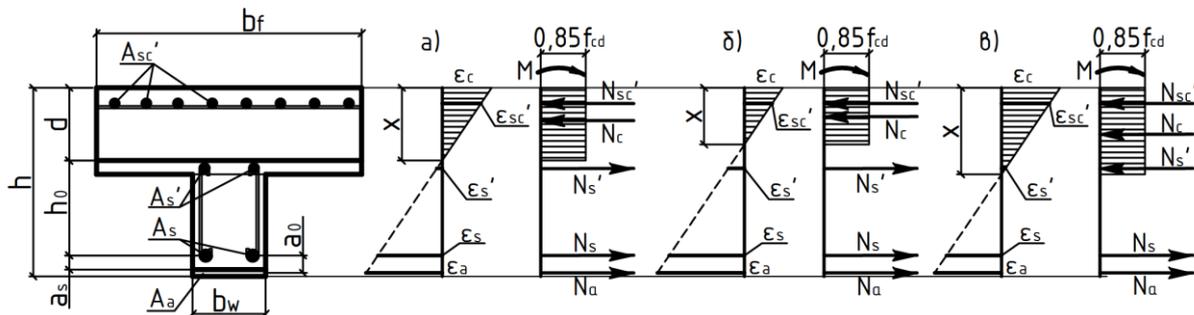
Напружено-деформований стан приведенного комбінованого таврового перерізу залізобетонного балкового елемента, що підсилюються шляхом нарощування перерізу додатковими залізобетонним шаром в стиснутій зоні та армуванням в розтягнутій зоні у вигляді поздовжніх арматурних стержнів: а) при  $x=d$ ; б) при  $x<d$ ; в) при  $x \leq d+h_f$ .
